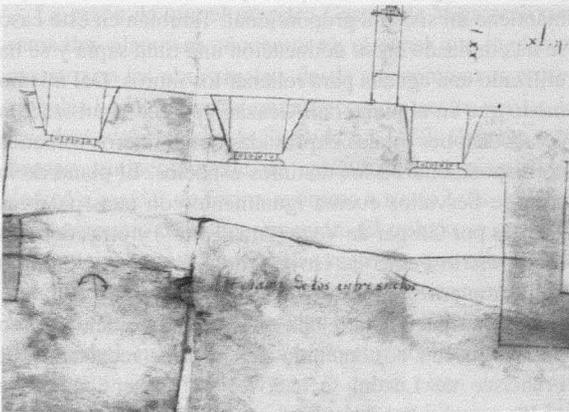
Detalle de la grafía aparecida en el plano del Alcázar.
